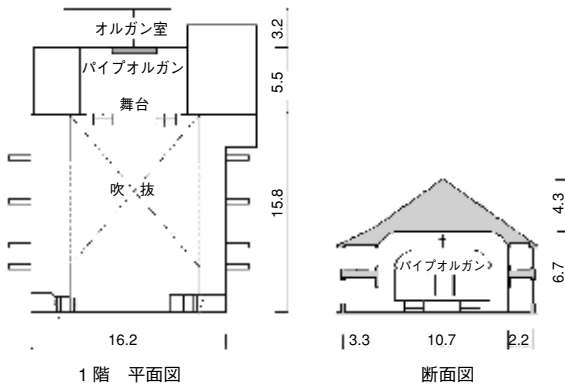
玉川学園礼拝堂平面図と断面図(単位：m)
